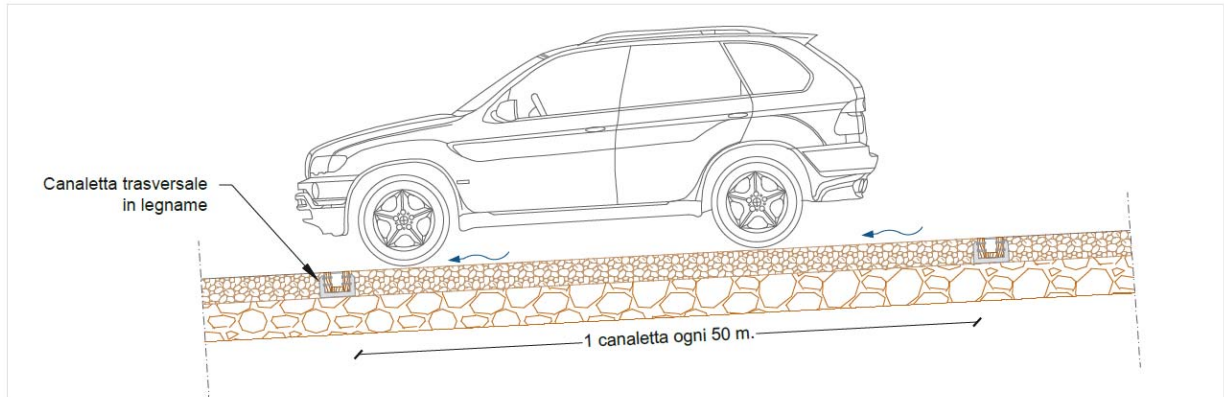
Sezione longitudinale con ubicazione delle canalette in legno.
